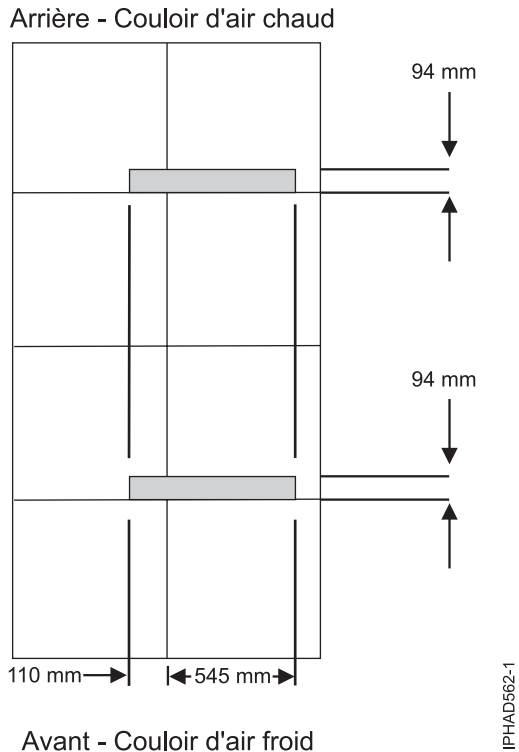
Positionnement des coupures de câble pour dalles de plancher de 600 mm
